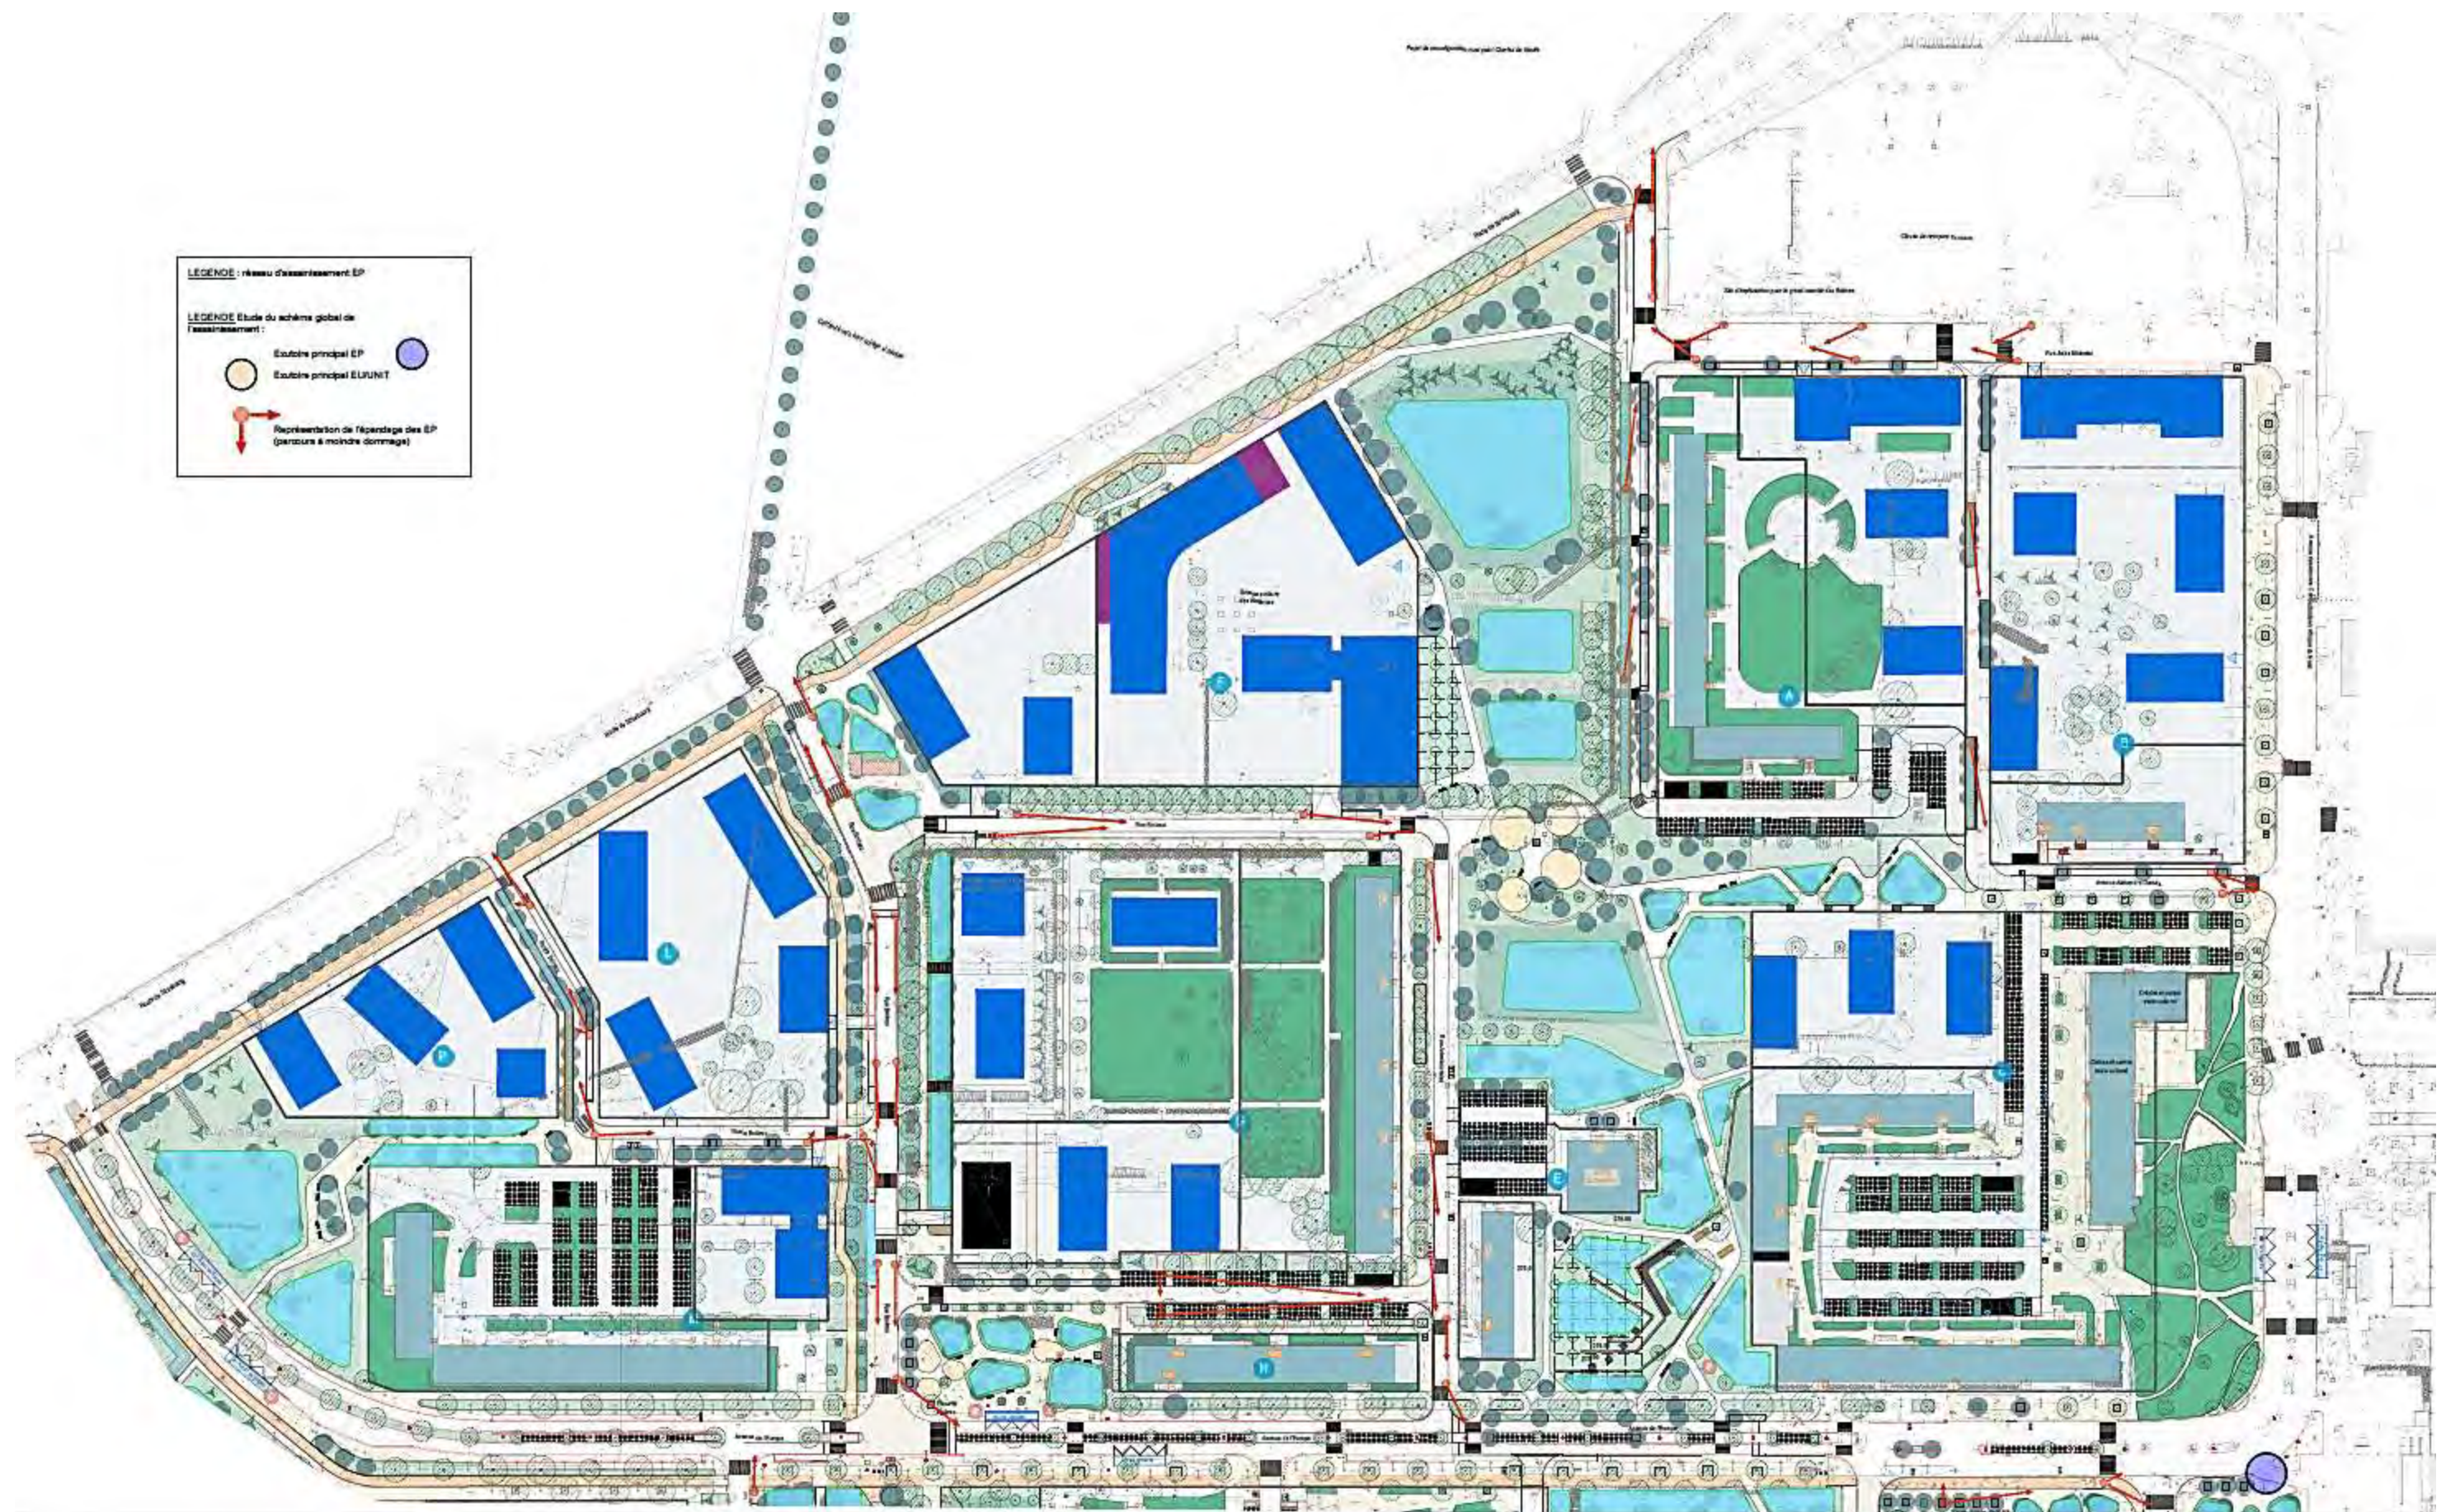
Plans de l'assainissement projeté (Source : Ingérop)
